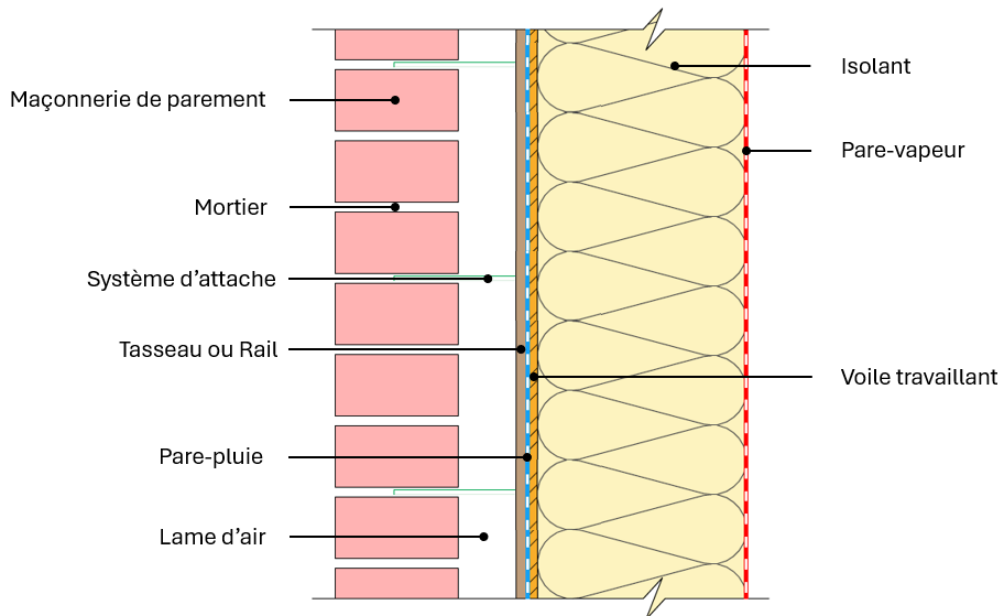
Coupe verticale d'un mur double maçonné sur ossature bois
